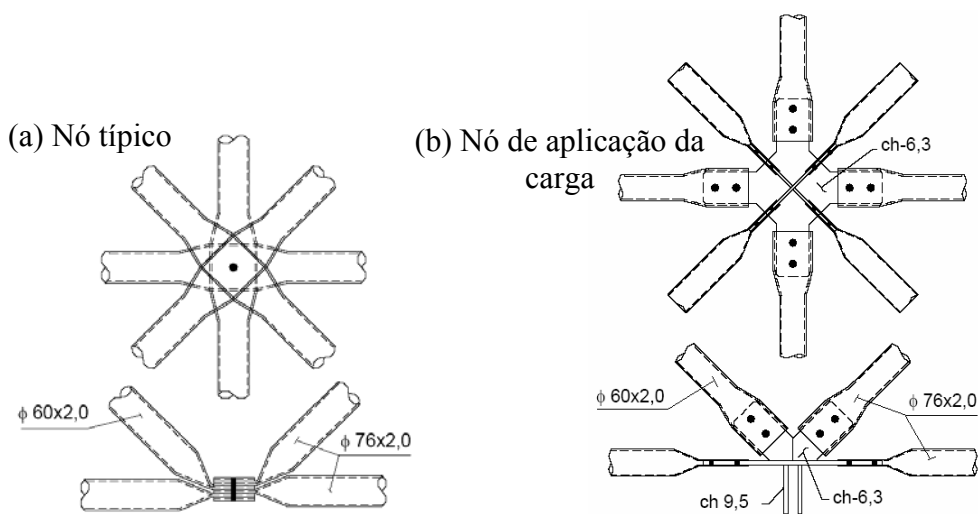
Ligação típica e nó de aplicação da carga (Souza, 1998)
